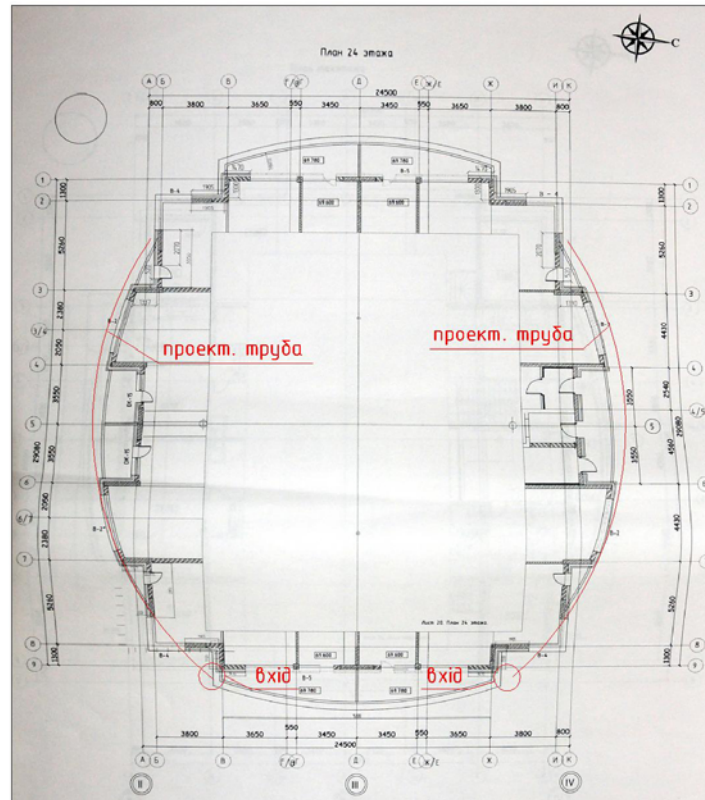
Рекомендації по влаштуванню проектованої труби вздовж фасадів по осі А, К в рівні перекриття 24 поверху для вивішування альпіністів (варіант 2).
